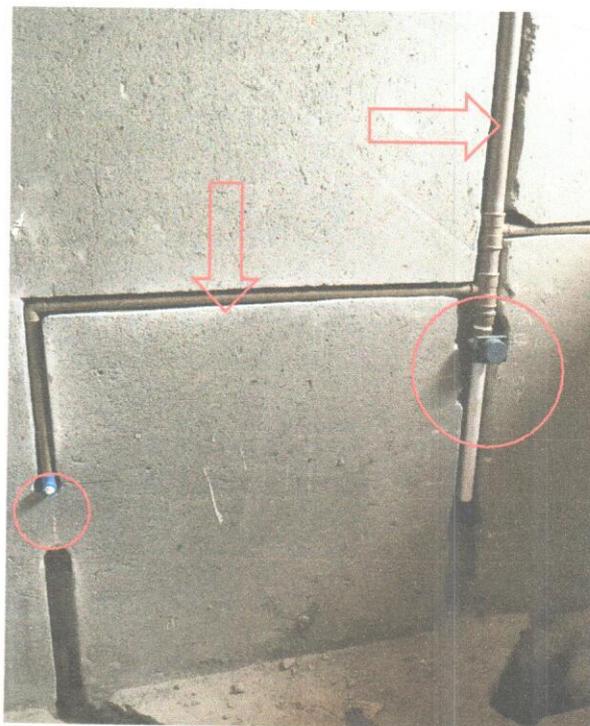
Tubos e conexões em PVC rígido para a alimentação dos aparelhos devidamente instalados.
